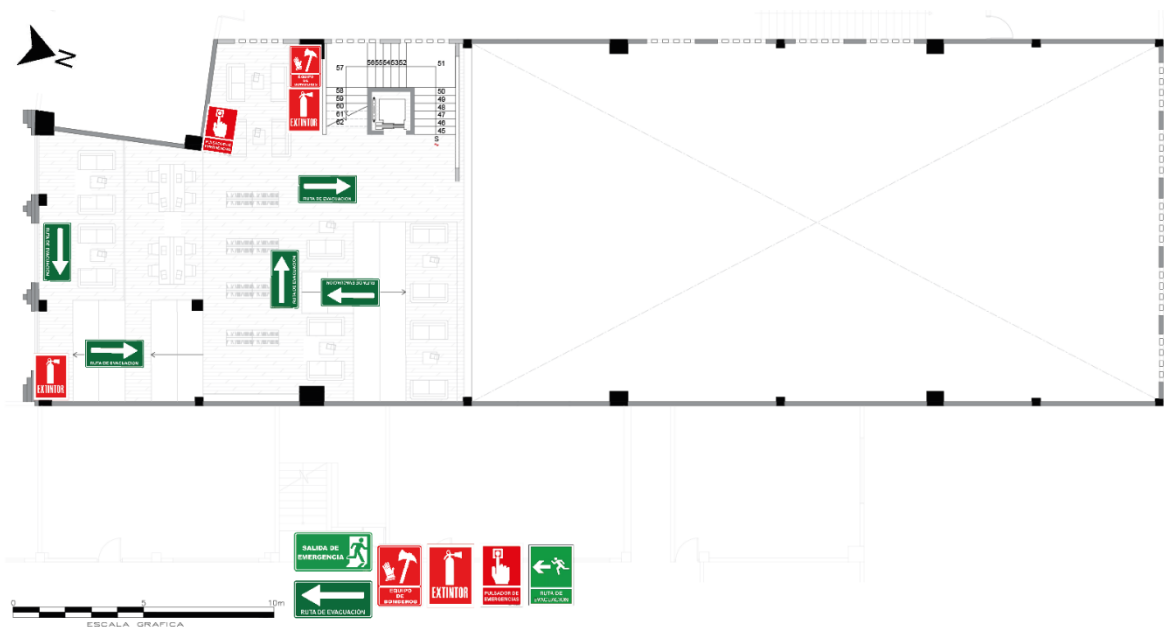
Disposición de los elementos contra incendios en la segunda planta alta
